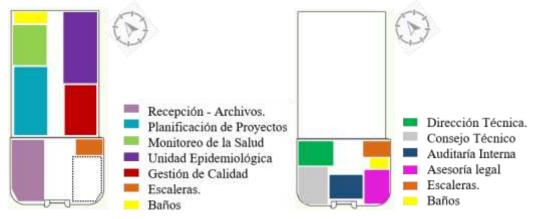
Análisis Espacial. Planta Baja Unidad Sanitaria Planta Alta Unidad Sanitaria.
